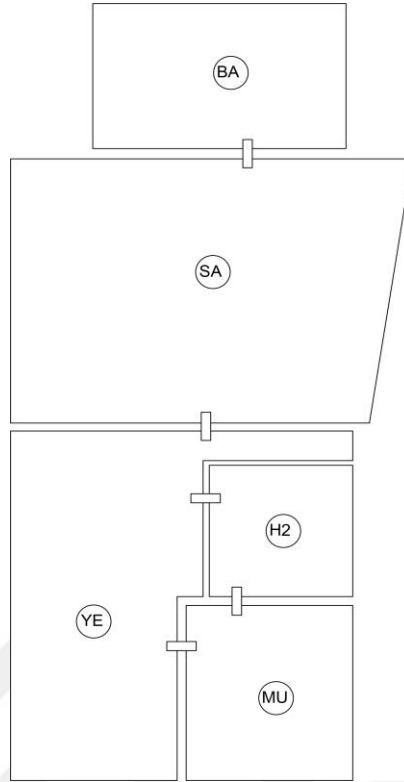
Şemsettin Sırer Yalısı üçüncü kat planı
